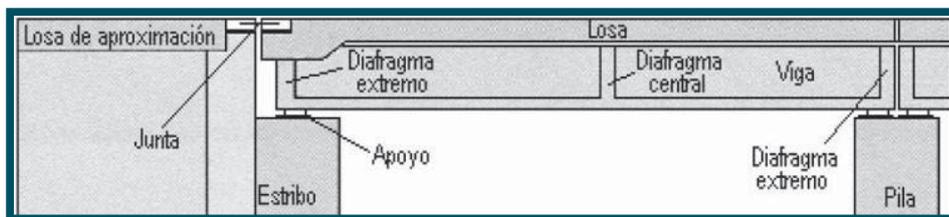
Elementos característicos de la superestructura de un puente (IMT, 2009)
